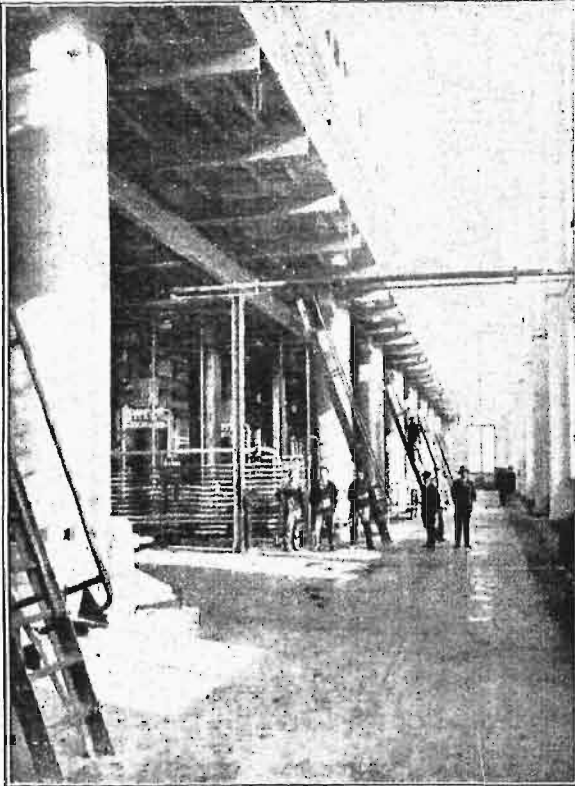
Hala instalacji przygotowania mieszanki (druga połowa).
